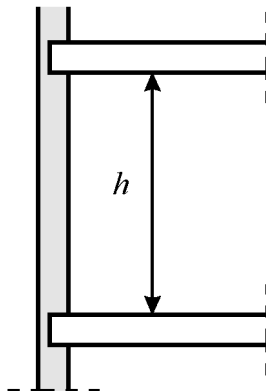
Muro actuando como apoyo extremo de un forjado
